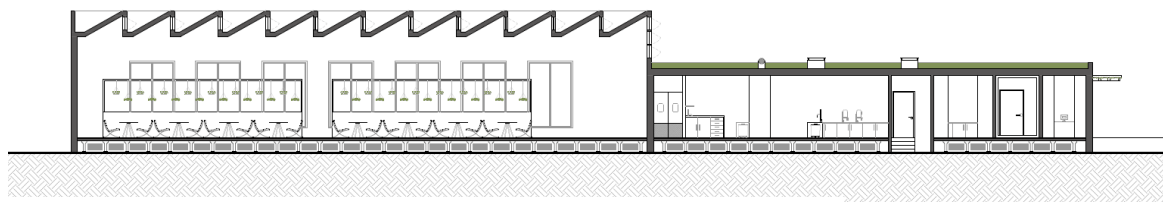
Corte esquemático do equipamento 1 (Restaurante).
